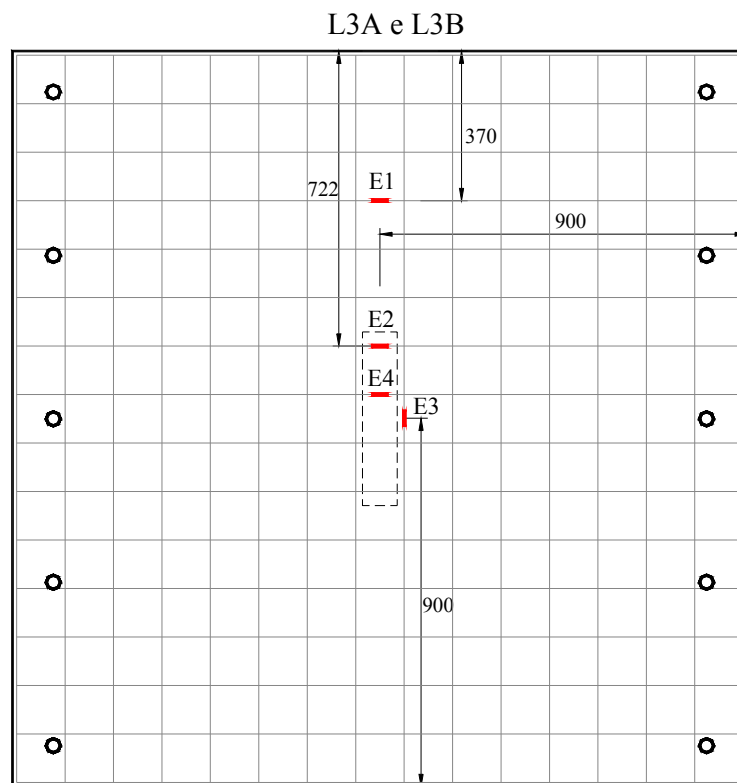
Posicionamento de extensômetros nas armaduras principal e secundária das lajes L3A e L3B
